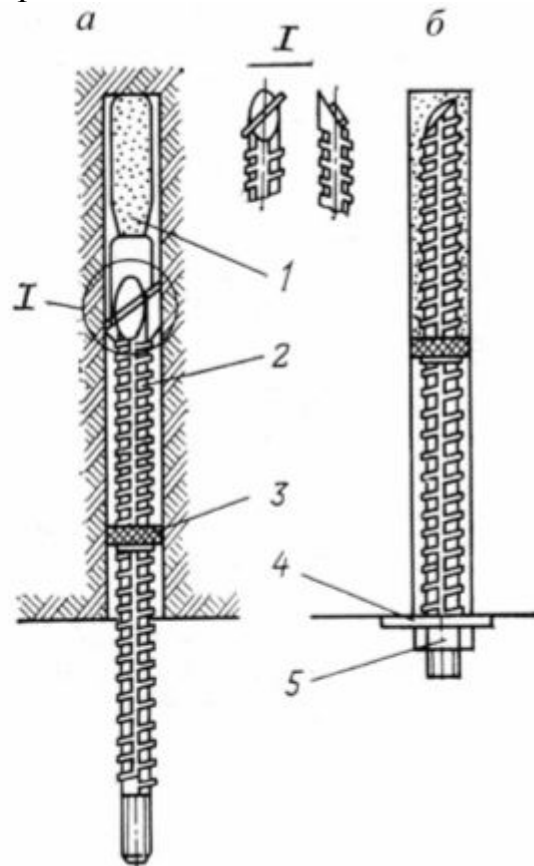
Анкер с закреплением патентованными быстротвердеющими смесями на цементной основе (АКЦ): а – в момент установки; б – после закрепления.
